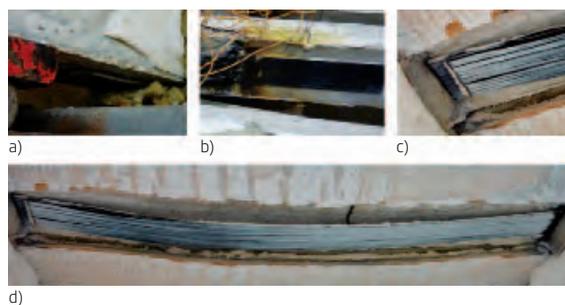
Modo de rotura do reforço na *Viga CFRP*: a) descolamento da extremidade do laminado; b) comprimento do laminado que ficou protegido; c) isolamento do laminado na zona da parede do forno; d) zona central do laminado completamente destacada da viga.
